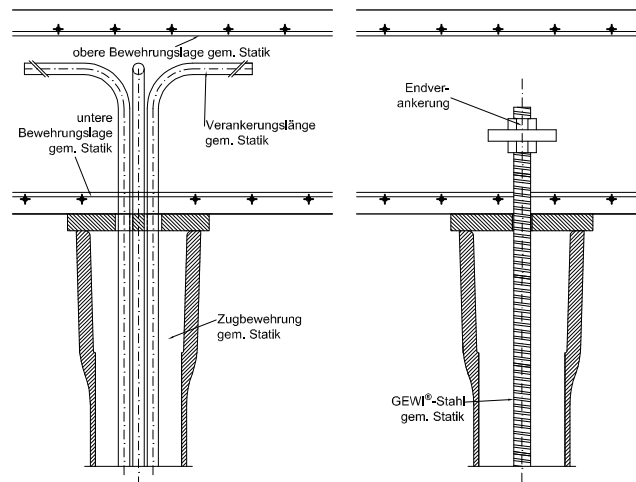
Mögliche Ausführungsvariante einer lastverteilenden Kopfplatte eines Zugpfahles, wobei links die Zugbewehrung mit Bewehrungsstäben und rechts mit GEWI®-Stahl ausgeführt ist ([24], adaptiert)
